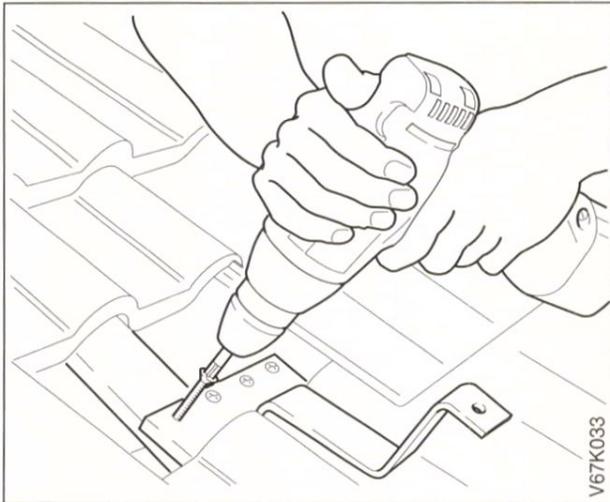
Sparrenanker mit Spax-Schrauben (6x80) befestigen. Wenn die Dachlatten stärker als 30 mm sind, dann die Sparrenanker entsprechend unterfüttern.
